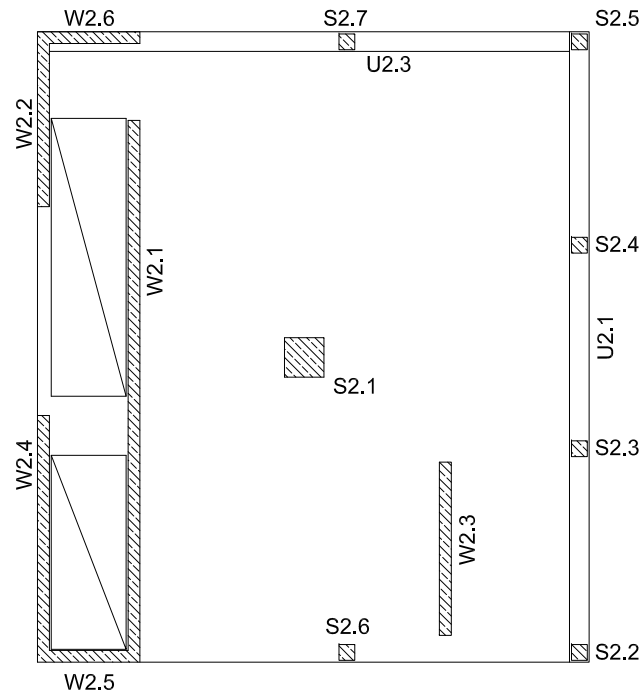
Bürohaus X: Grundriss 1. Obergeschoss [Lie09]
